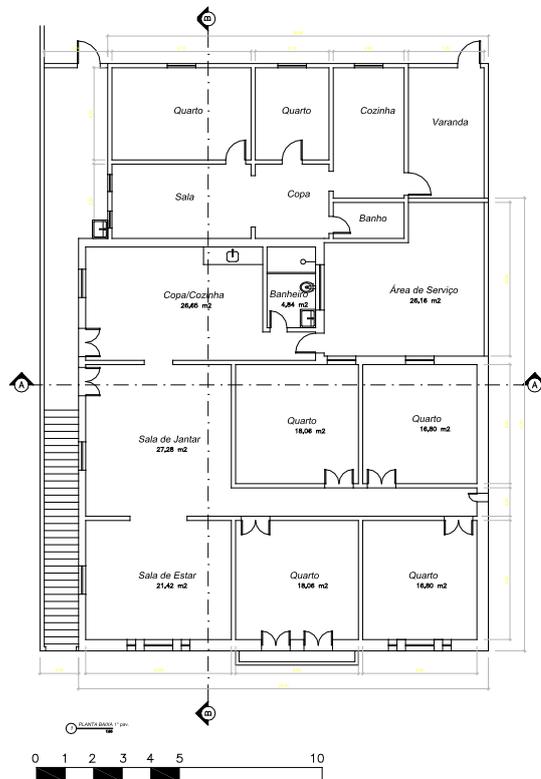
Planta segundo pavimento - Casa Leni Ayub
